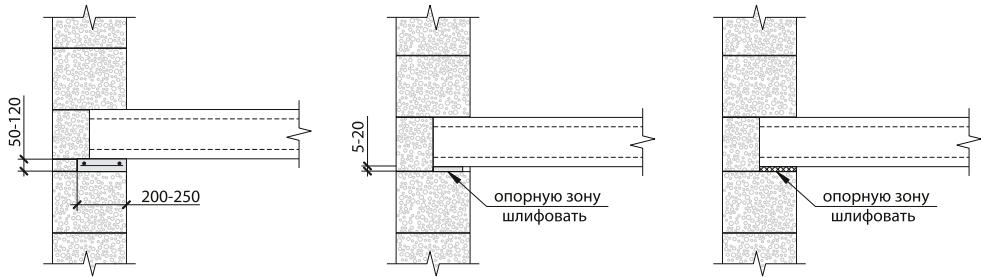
Варианты монтажа железобетонных перекрытий по стенам из блоков AEROC
